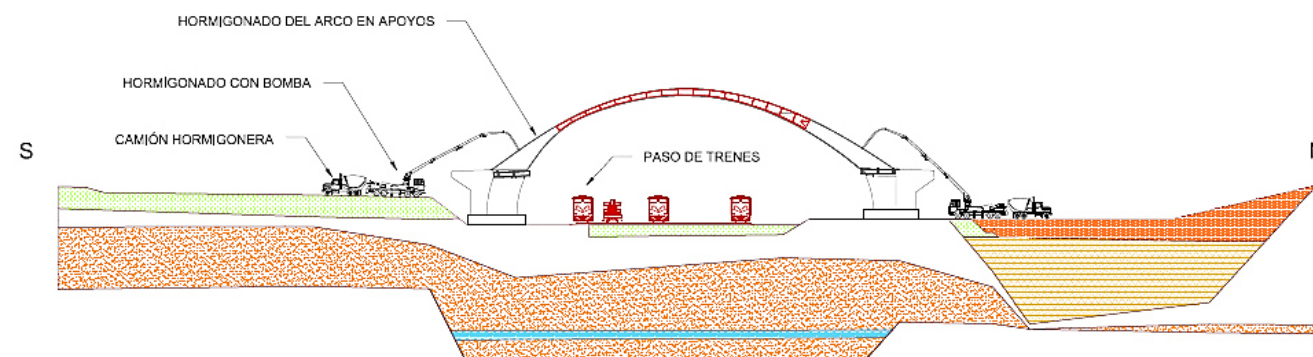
HORMIGONADO DEL ARCO EN LA ZONA DE APOYOS.
